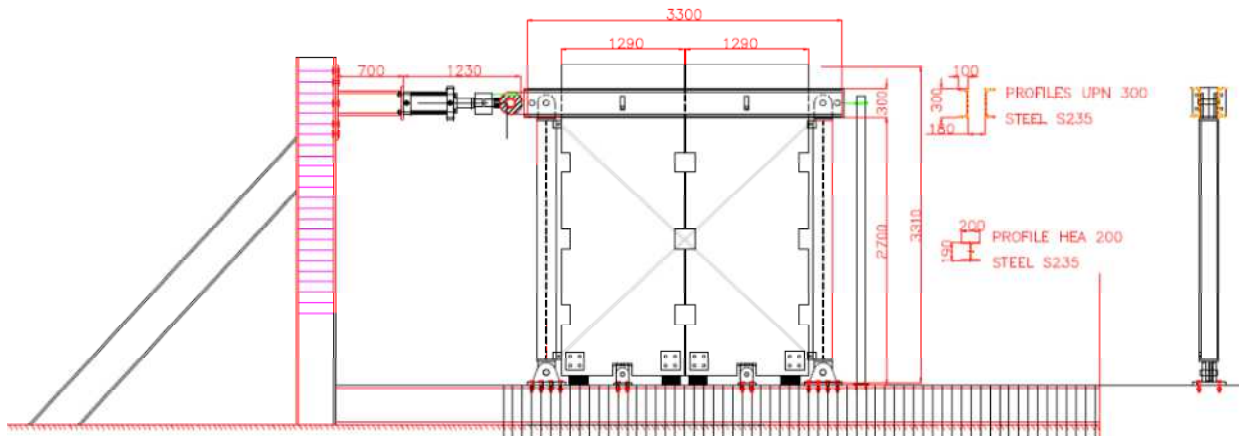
Schema dell'impianto di prova su sottosistema strutturale
